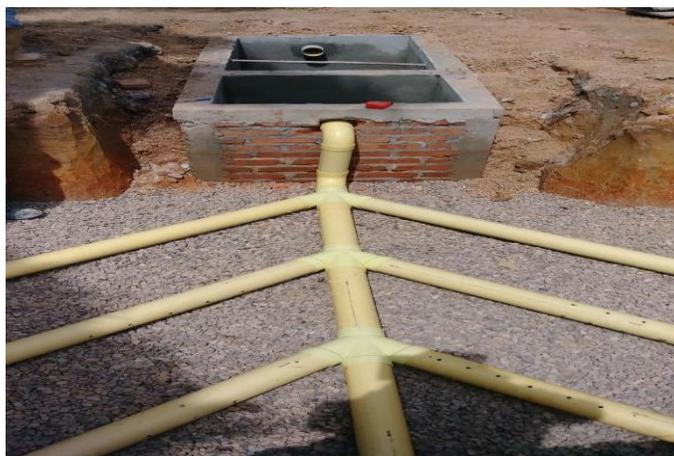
TUBERÍA EN ESPINA DE PESCADO
